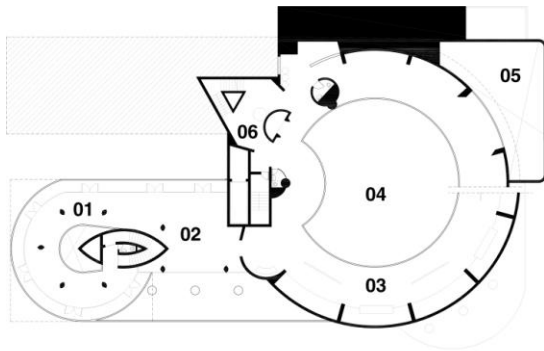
| Planta Primeiro Pav. | re-desenho Autora
